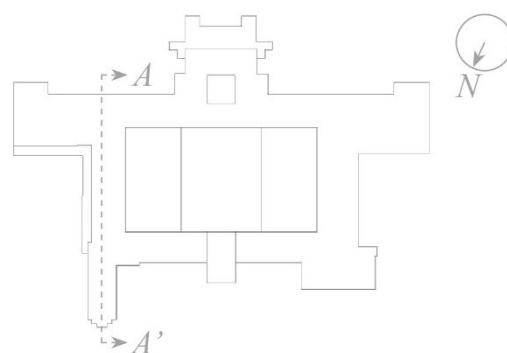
Planimetria schematica (Fonte: Elaborato dell'autore)
